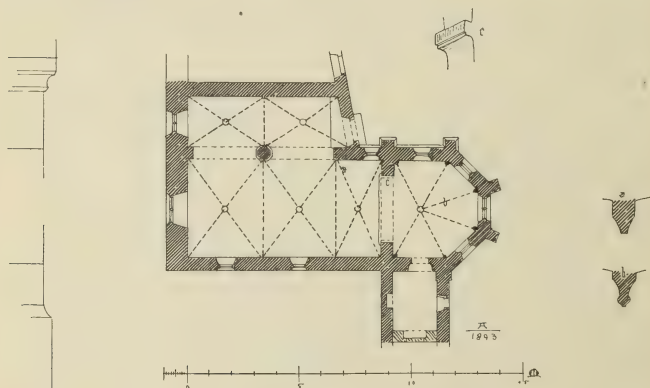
Züllich. Grundriss der Gasthauskapelle.
